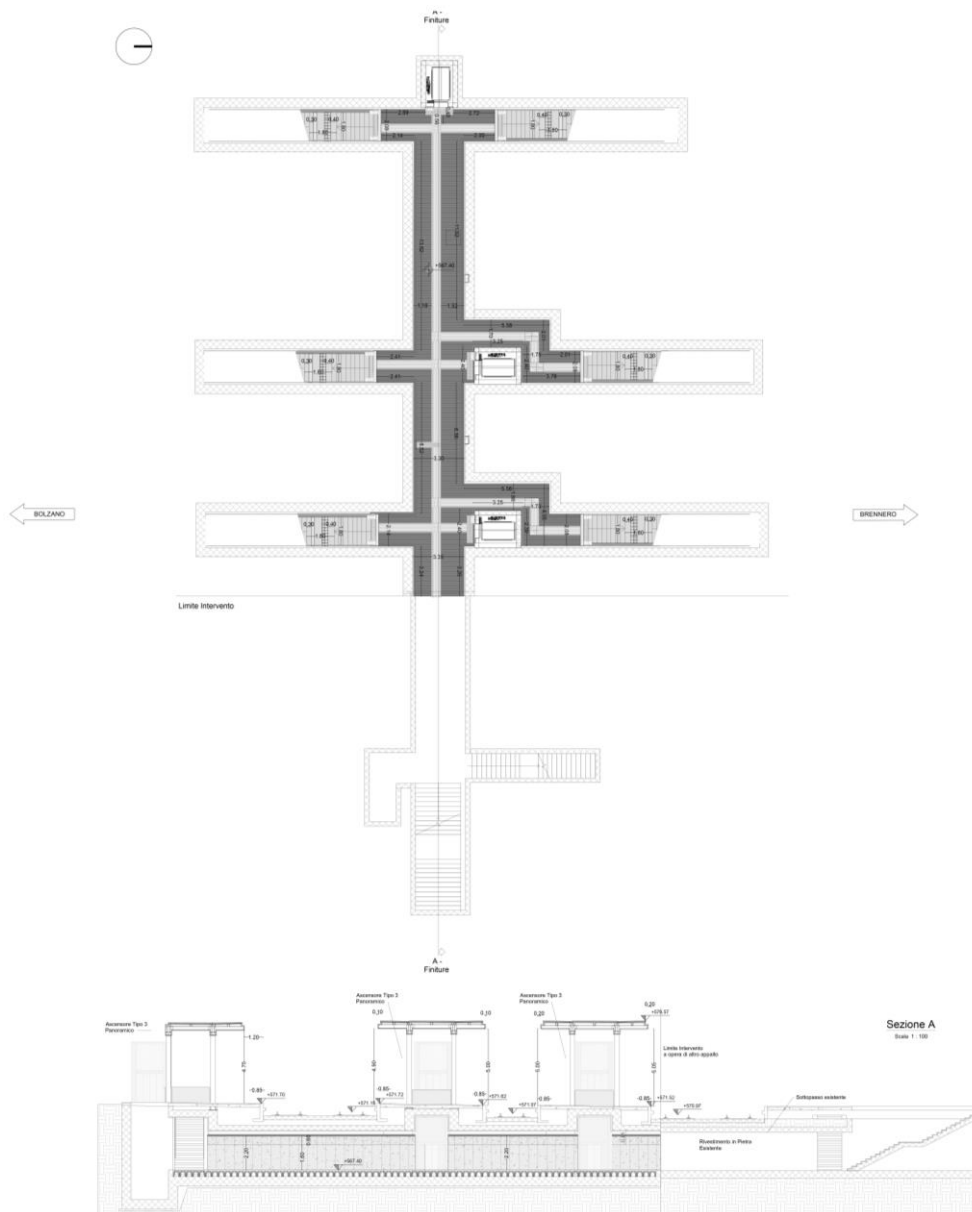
Prolungamento sottopasso esistente – Pianta e sezione longitudinale
